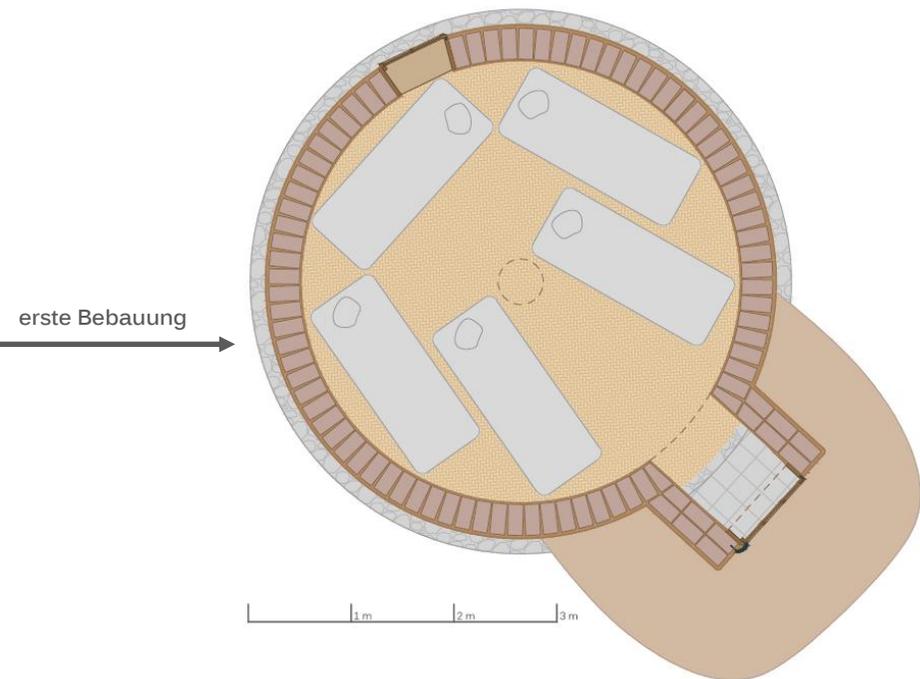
Grundriss der ersten Bebauung mit fünf Schlafplätze
